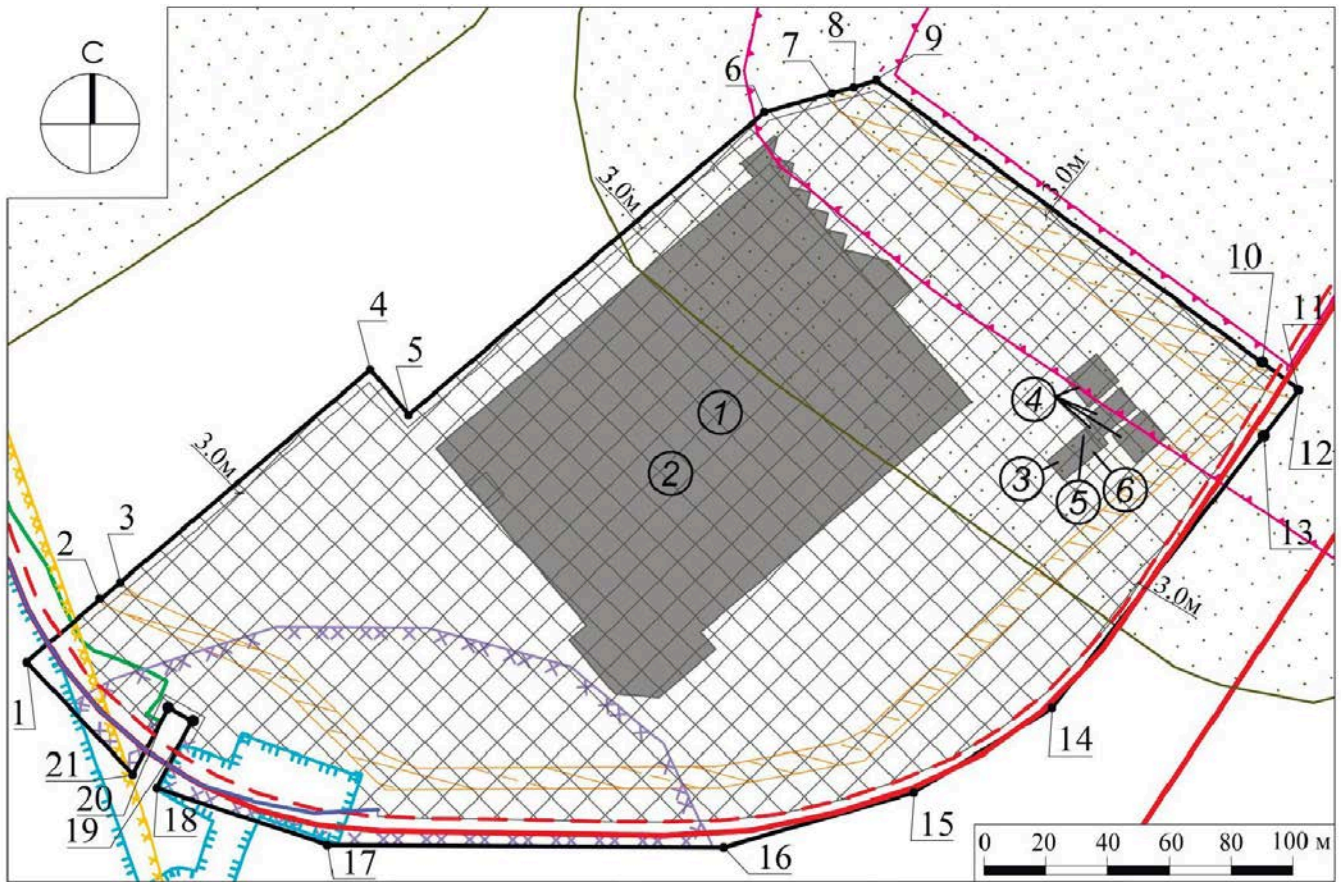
Фрагмент чертежа градостроительного плана земельного участка (приложение №1 к настоящему заключению)
